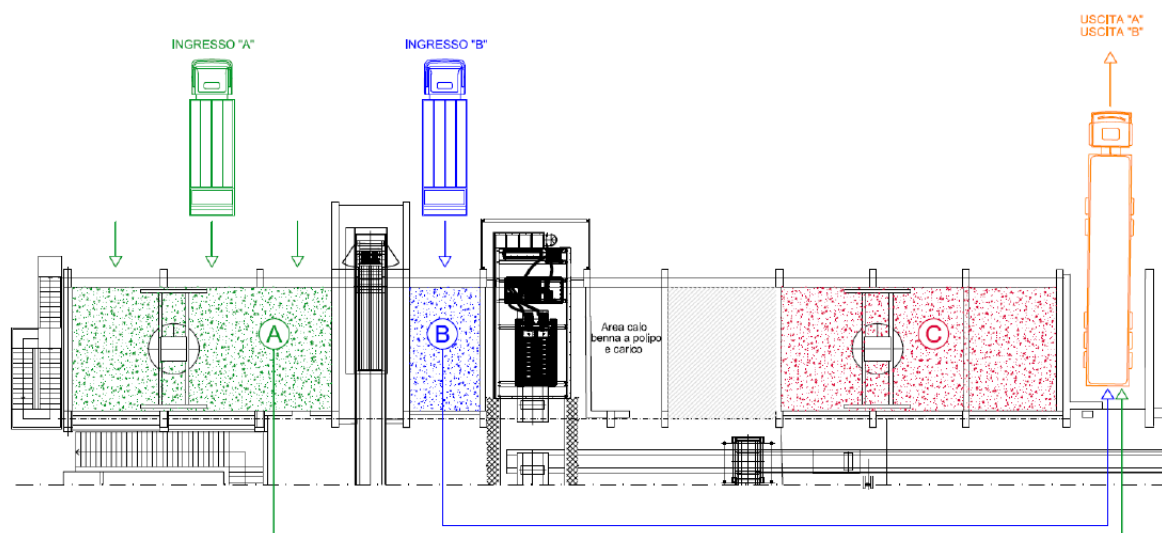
Planimetria fosse dedicate alle fasi di trasferimento RDM
